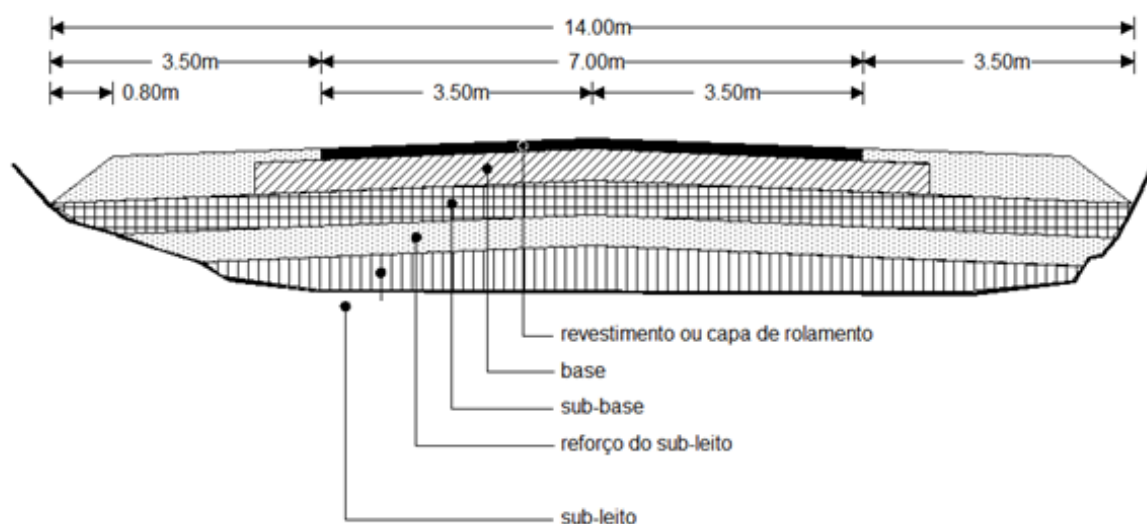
Esquema das camadas de um pavimento observando as diferentes funções, apoiadas e construídas sobre o subleito na fundação do pavimento.
